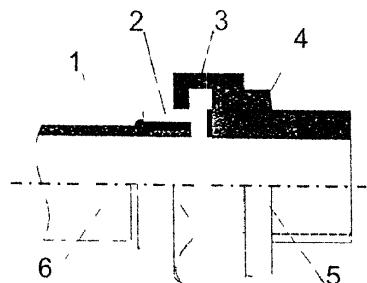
Соединение с накидной гайкой 1 - труба из PPRC; 2 - деталь из PPRC; 3 - накидная гайка металлическая; 4 - резьбовая деталь; 5 - прокладка; 6 - сварной шов
